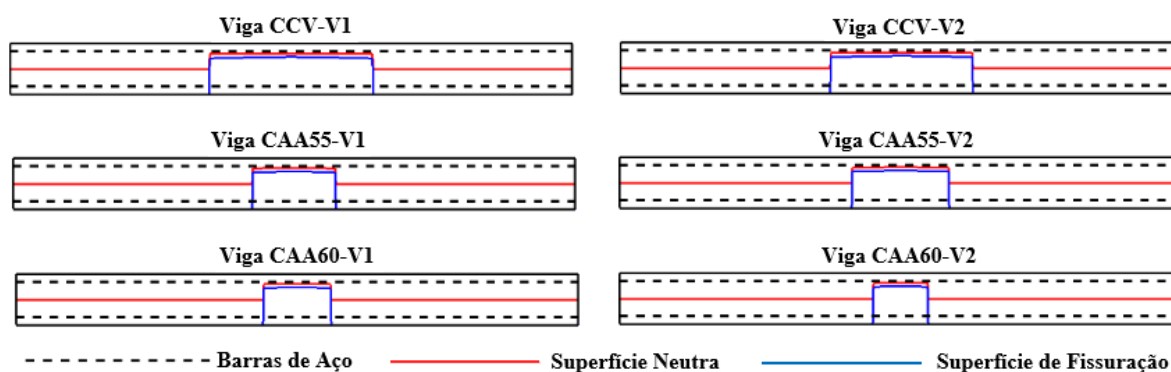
Região de fissuração das vigas ensaiadas por Simonetti (2008). Fonte: O Autor (2016).
